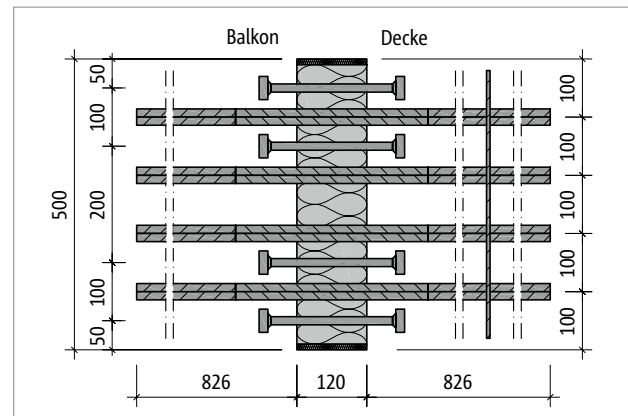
Schöck Isokorb® XT Typ QP-VV9: Produktgrundriss
